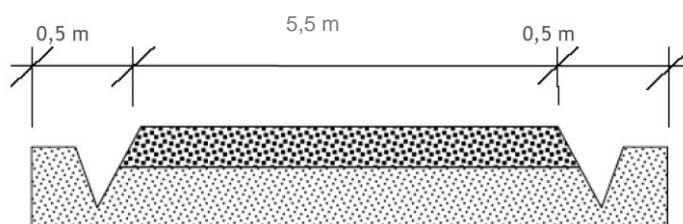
VUE EN COUPE D'UNE PISTE D'ACCES
